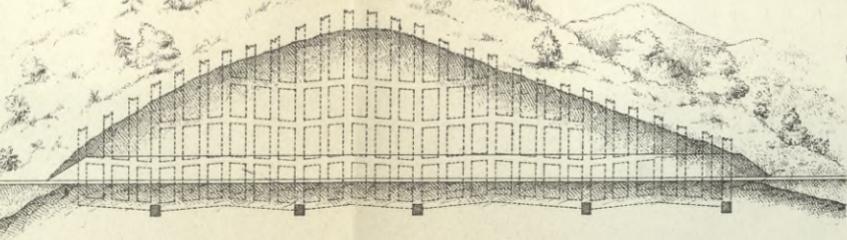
Einschnittrutschung an der Westfälischen Eisenbahn.
